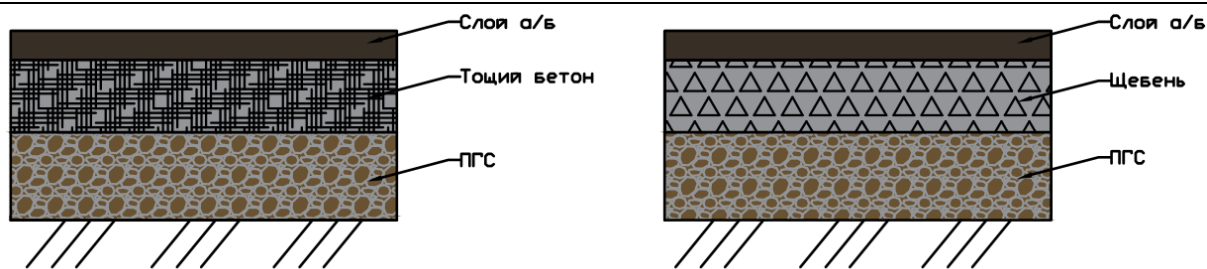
Конструкции нежестких аэродромных покрытий из асфальтобетона.
